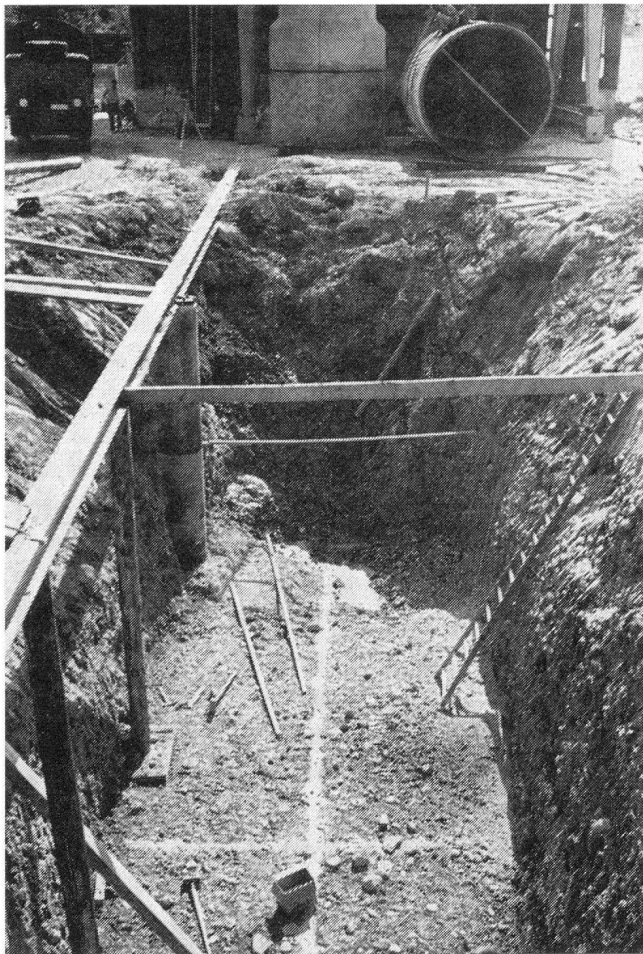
Vorbereitete Baugrube von 4,5 m Tiefe für die Versenkung des Bauwerkes. Im Hintergrund verschweisste, zum Einbau bereitgestellte Elemente
